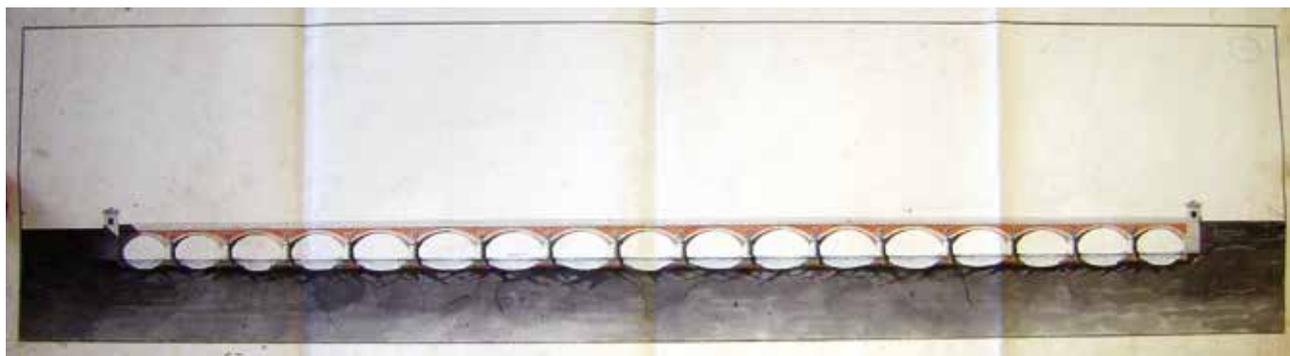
Élévation du pont de pierre, nd, vers 1818 (A.M.Bx., 132 O 1).
